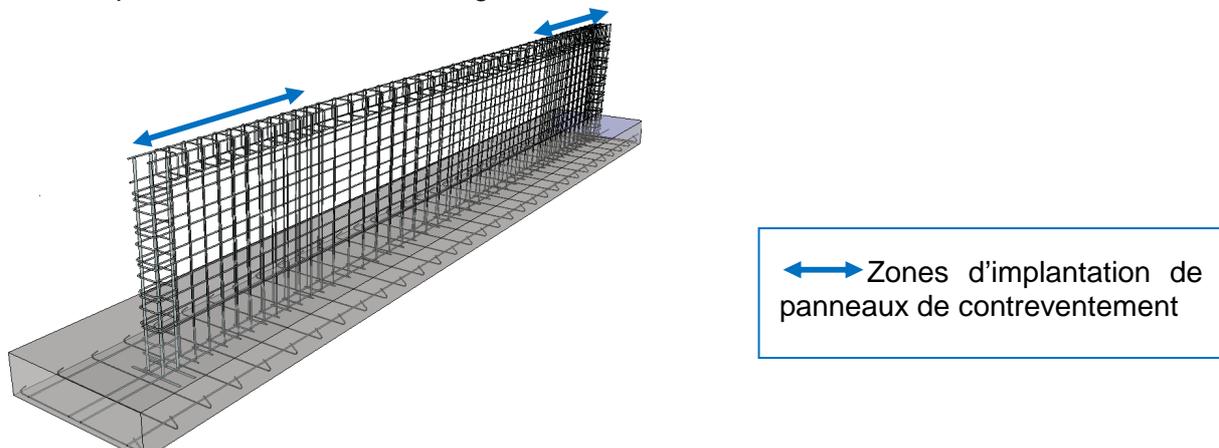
Représentation du principe de ferrailage d'une fondation de type semelle filante (vue en perspective).
